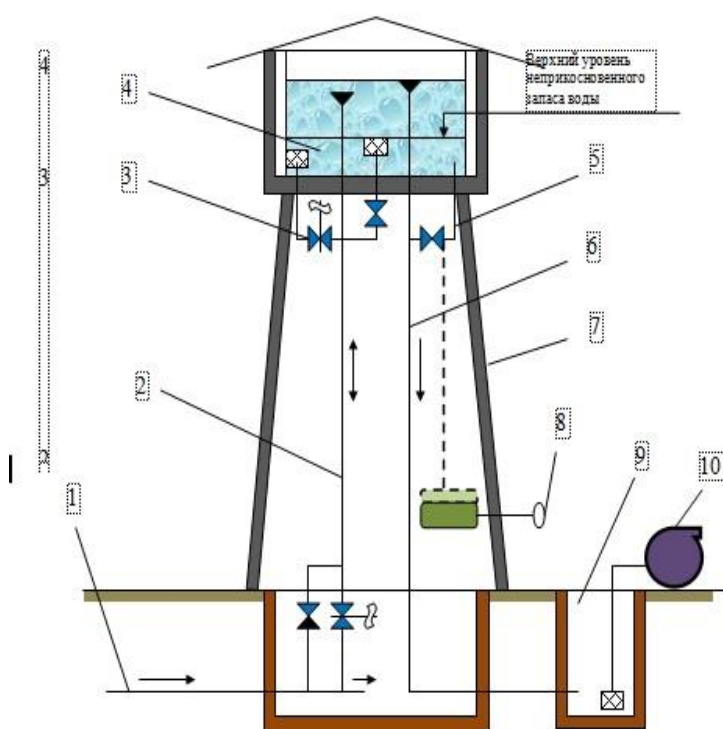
Схема оборудования водонапорной башни: 1 – водопровод; 2 – стояк для отбора воды; 3 – вентиль для включения подачи воды при пожаротушении; 4 – бак водонапорной башни; 5 – слив отстоя; 6 – переливная труба; 7 – основание башни; 8 – устройство спуска воды; 9 – водопроводный колодец; 10 – передвижной пожарный насос
